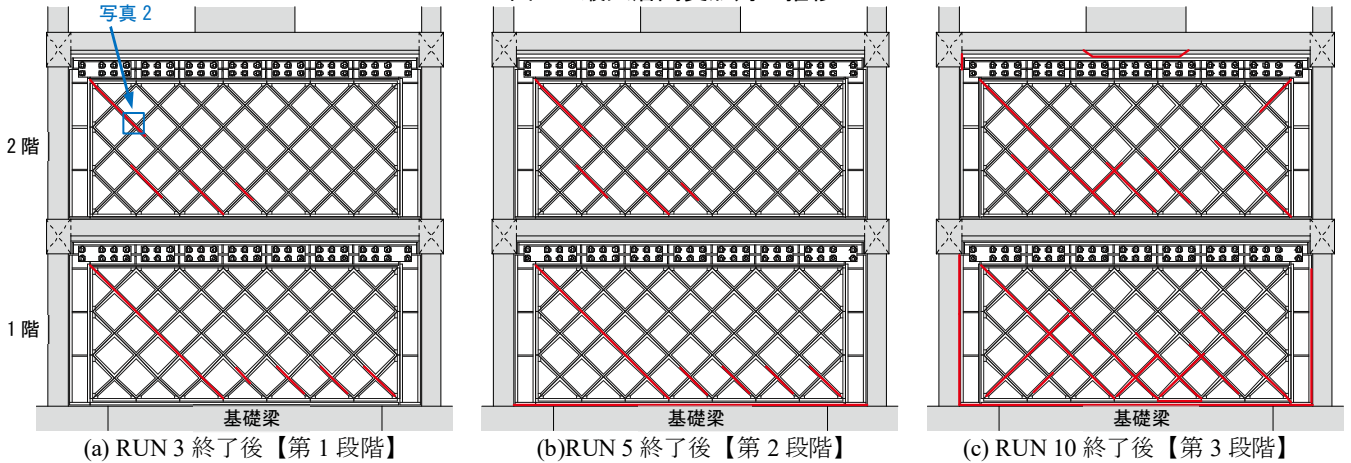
ブロック耐震壁の接着部におけるひび割れ分布状況 (— : ひび割れ箇所)
